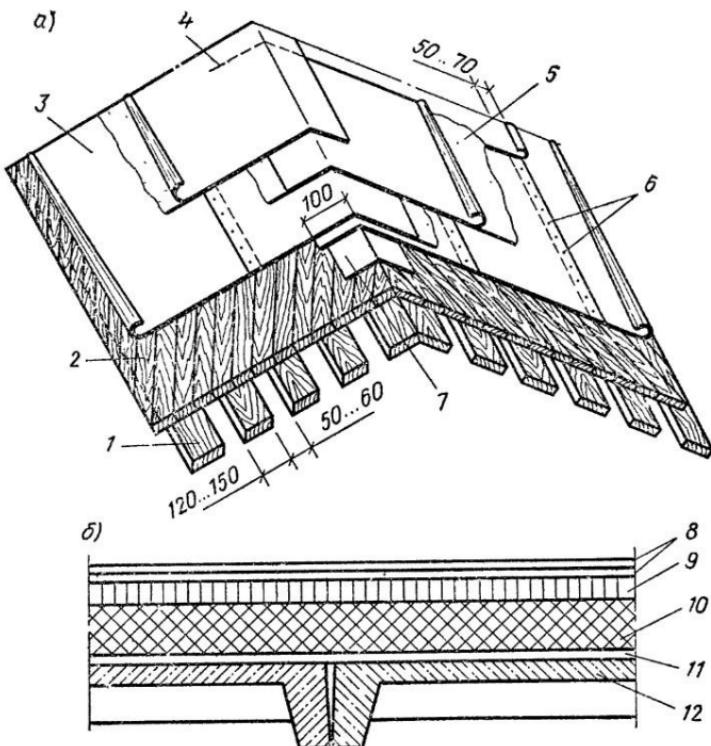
Рубероидные кровли (мягкие кровли)
